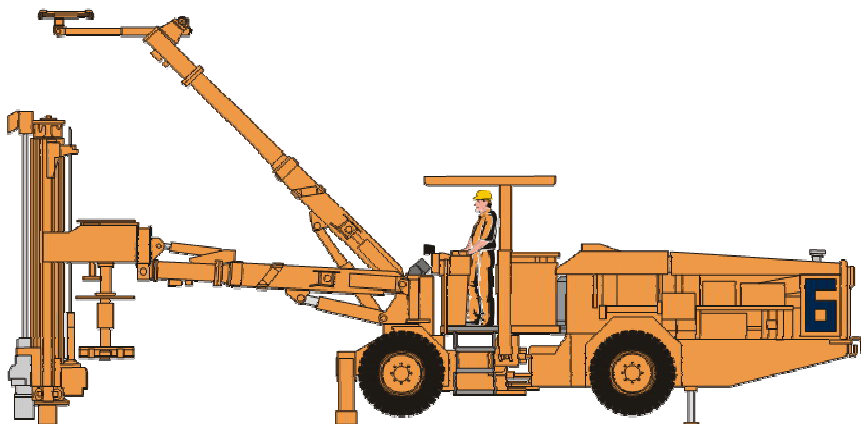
Общий вид установки для крепления анкерами Robot 6-126 XL Screen Cabin
